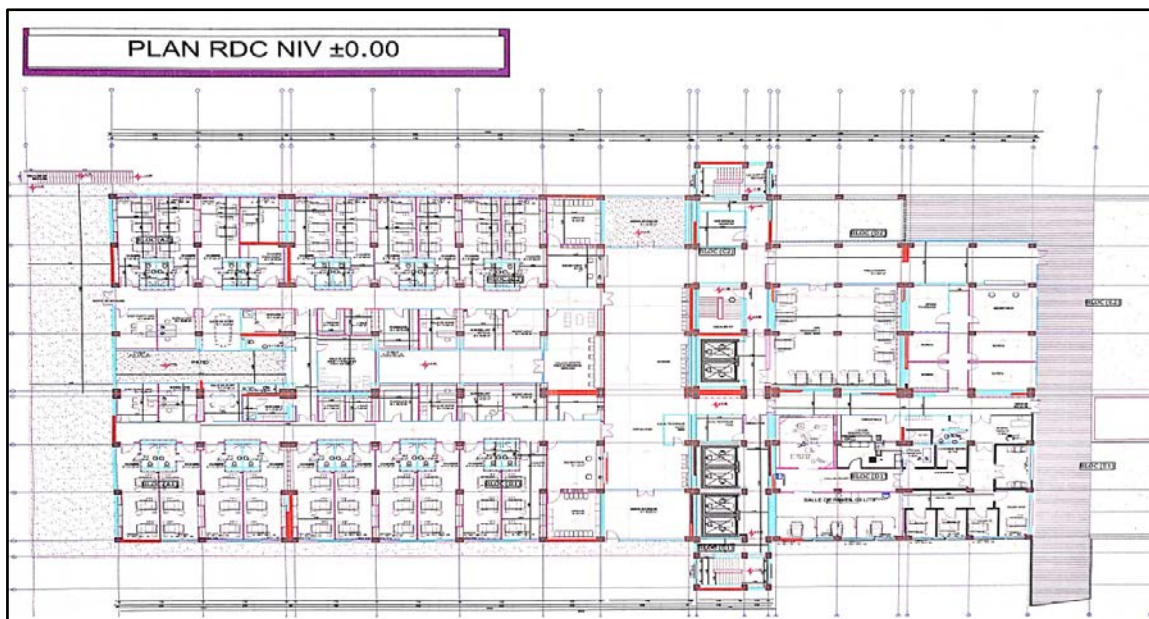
Plan rez-de-chaussée des nouvelle UMC
